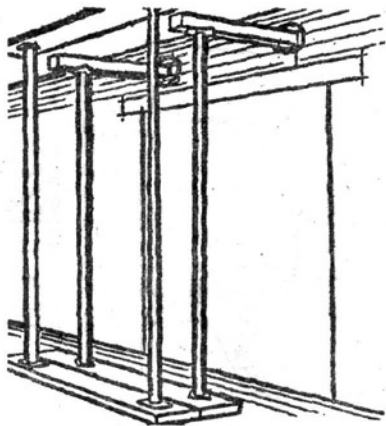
Схема опор, обеспечивающих стабилизацию междуэтажного перекрытия
